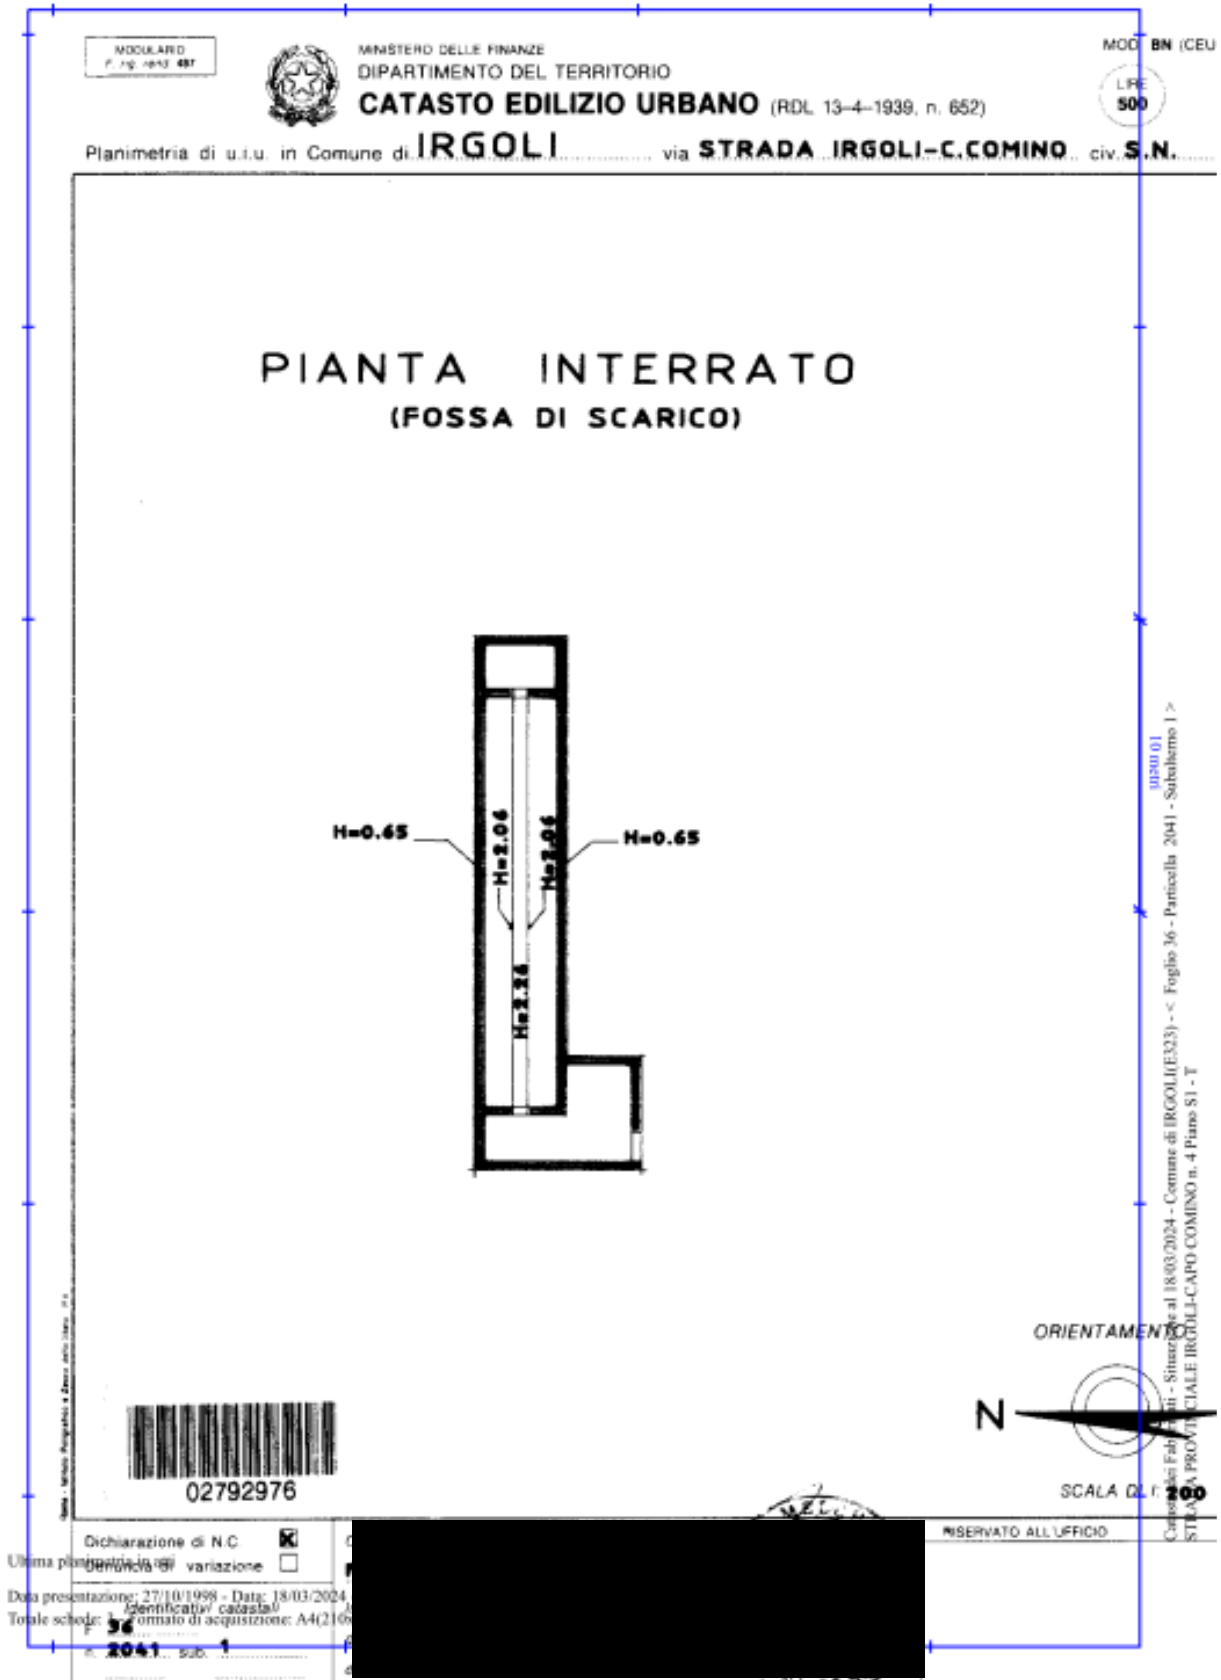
Planimetria del foglio 36 p.lla 2041 sub1/parte-Fossa di scarico
